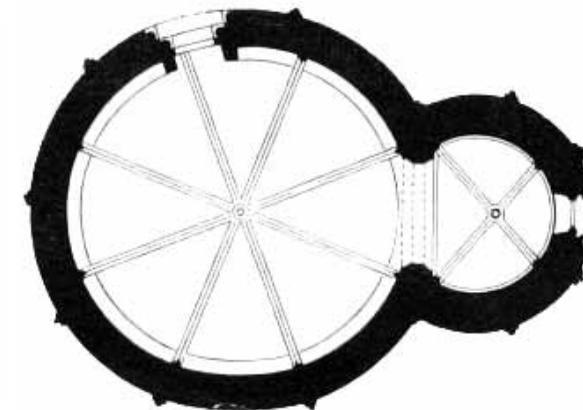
Grundriss Pulkau, M 1:200. MdkkCC 1886, 160.
